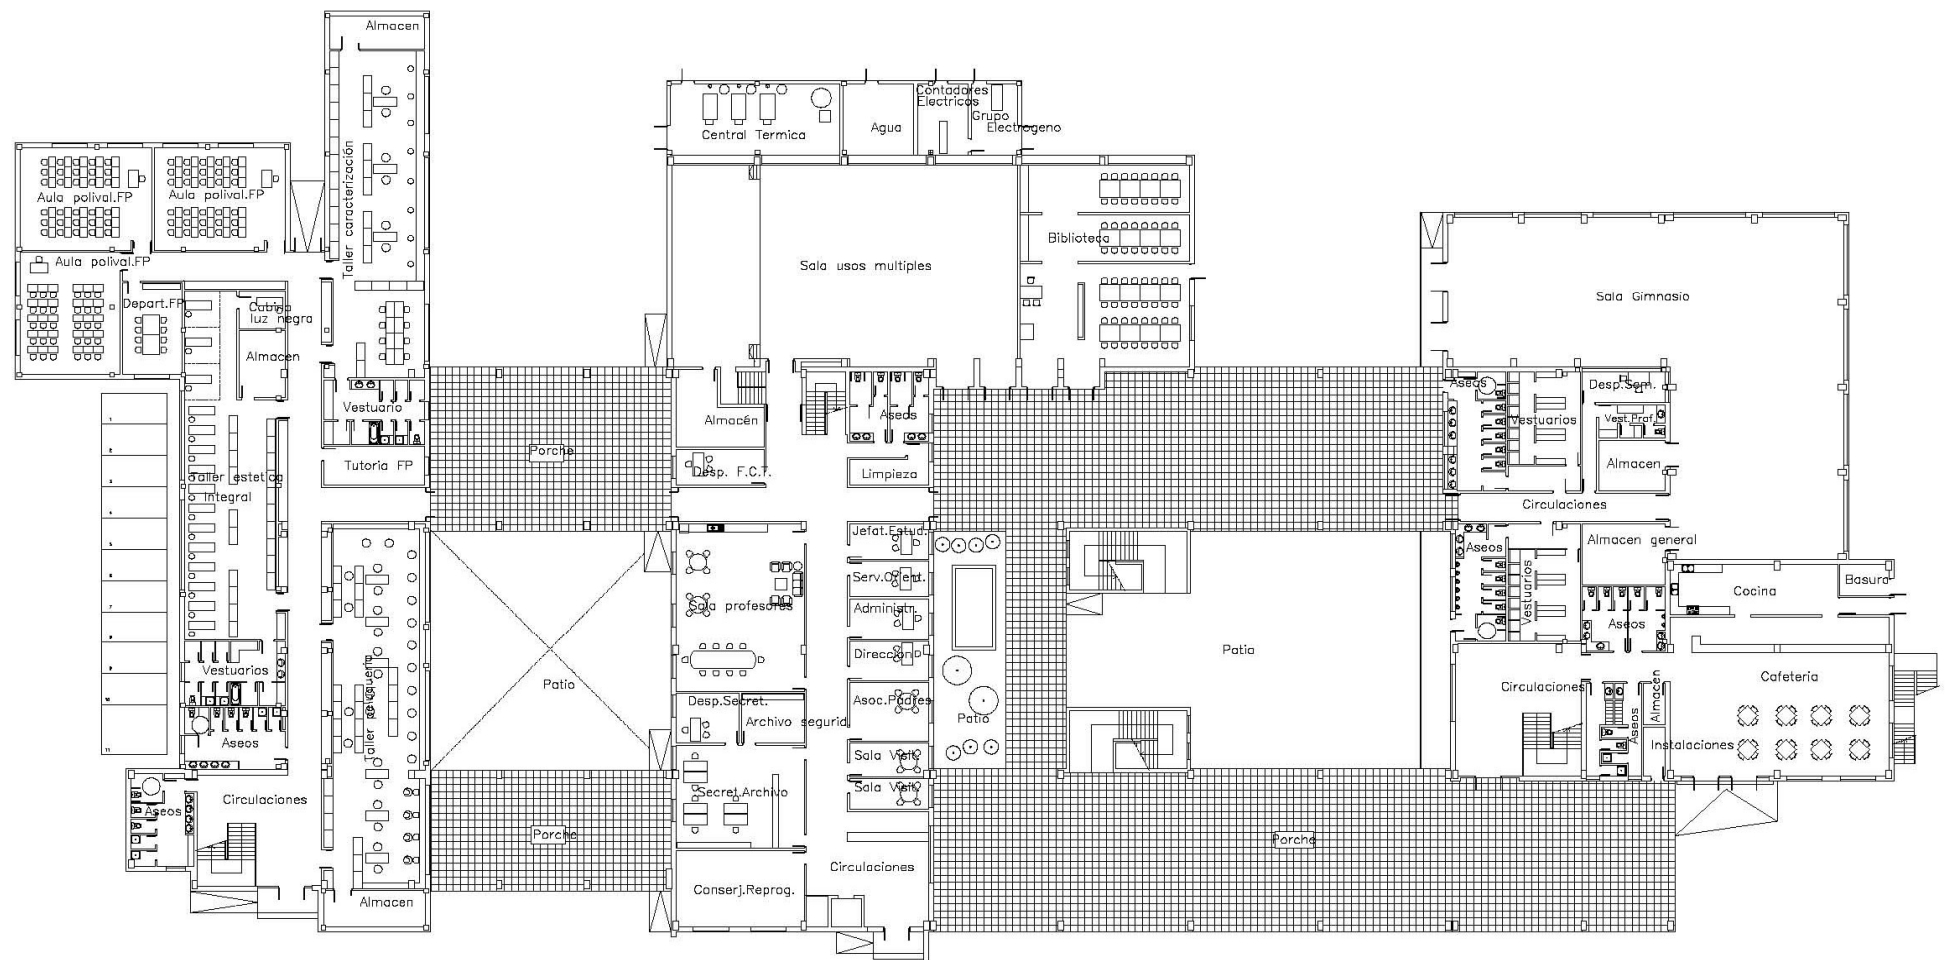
Plano de distribución Planta Baja (Fuente: proyecto)
